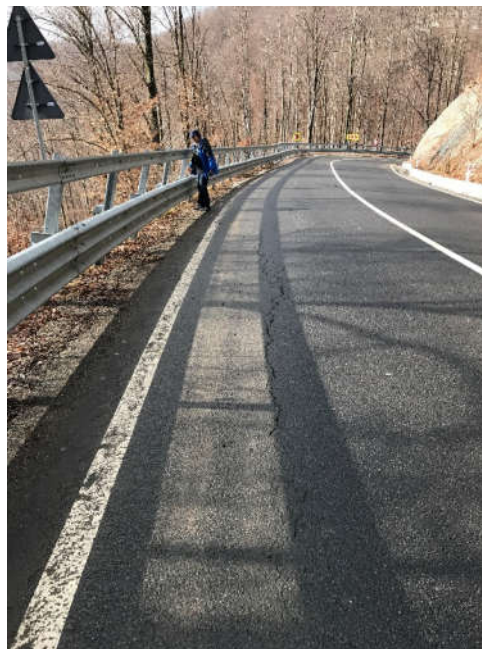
Poza 2 fisură structură rutieră km 9+100 - februarie
